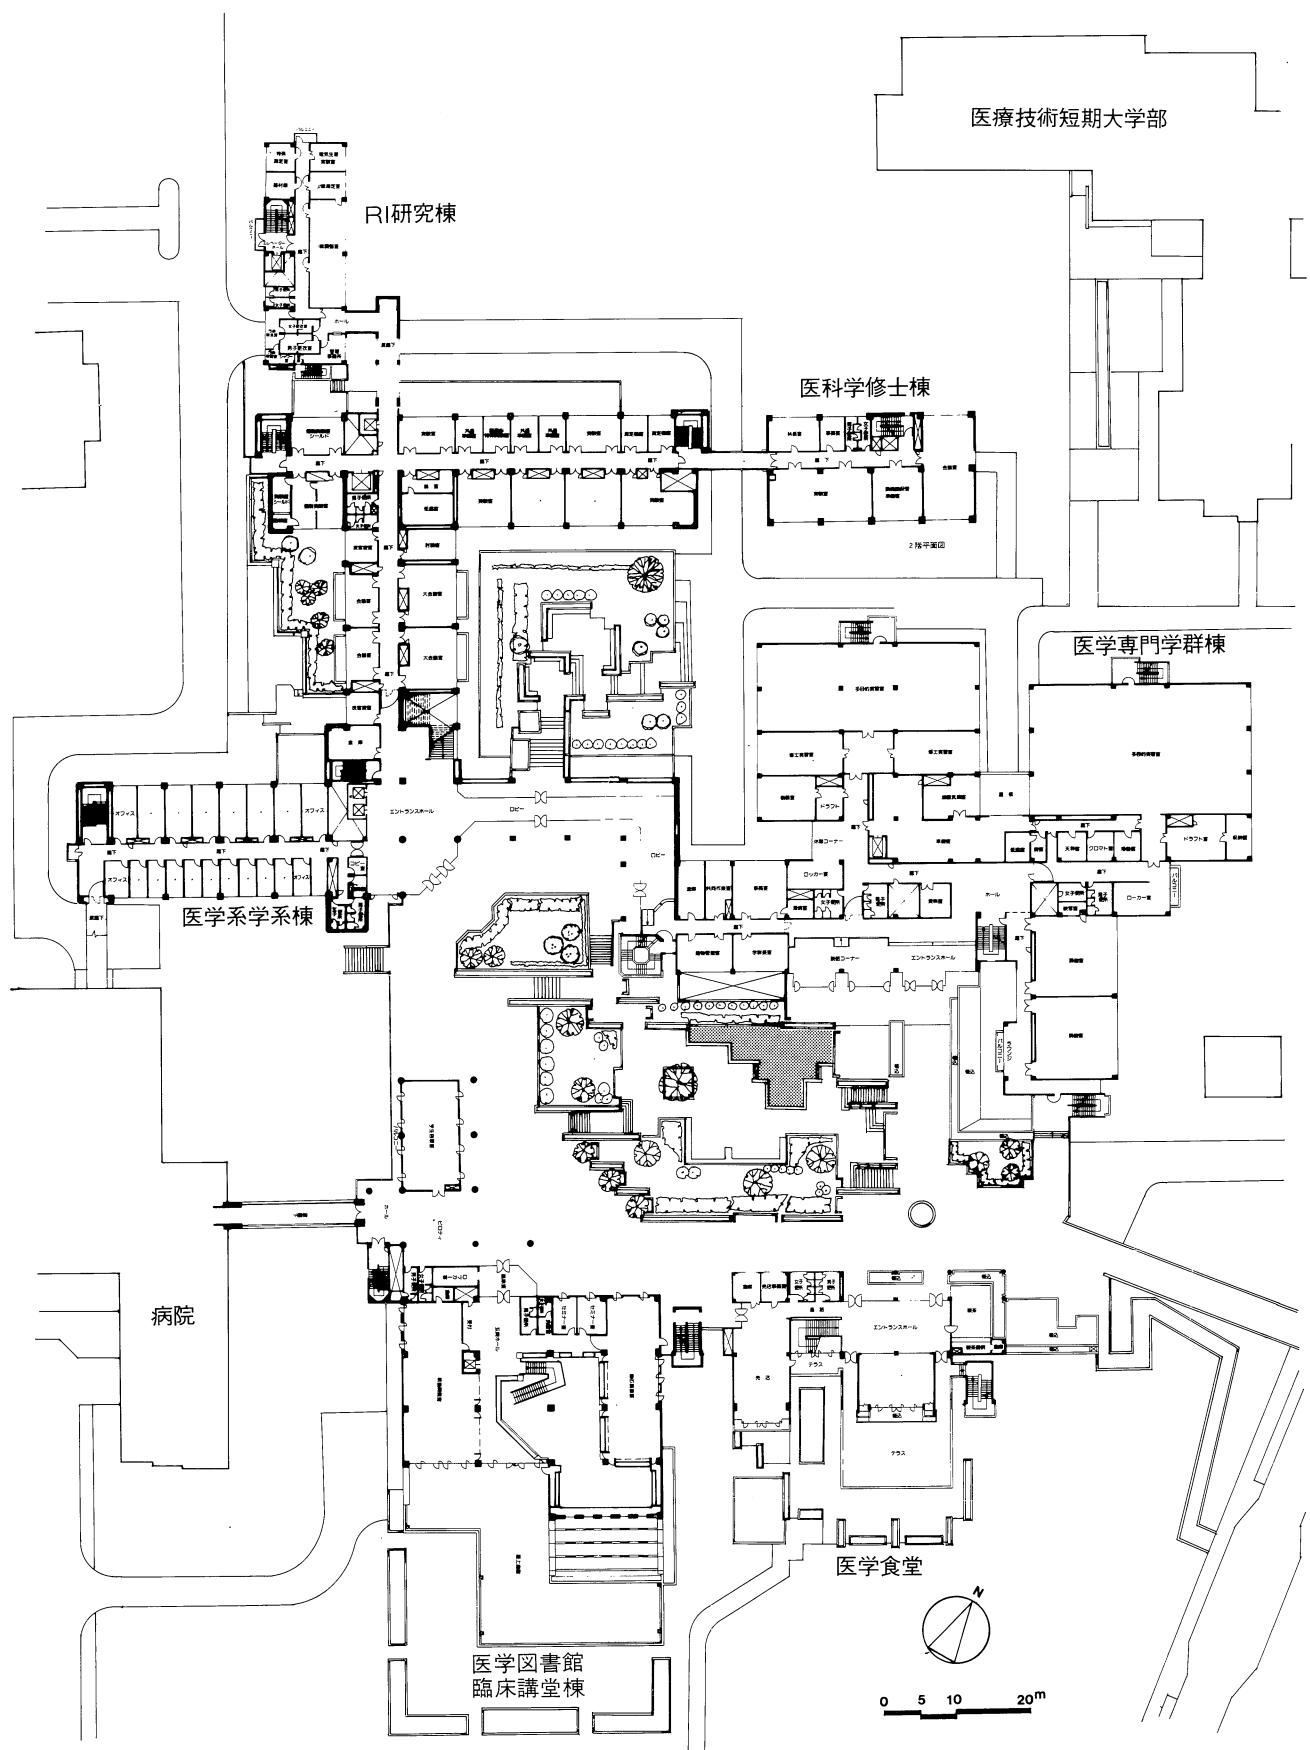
医学専門学群・学系主階平面図(2 F)
